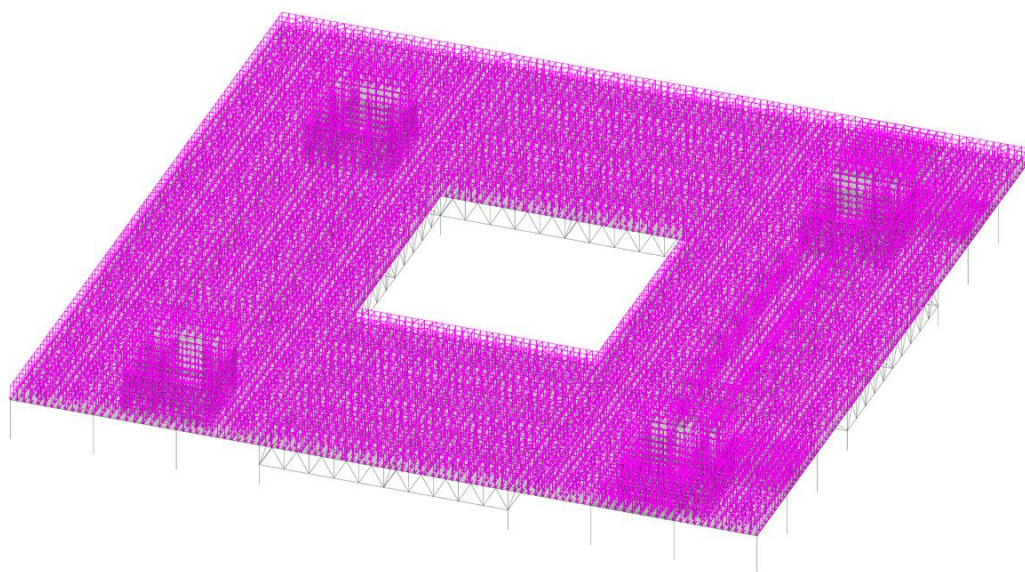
Схема распределения собственного веса железобетонных конструкций
